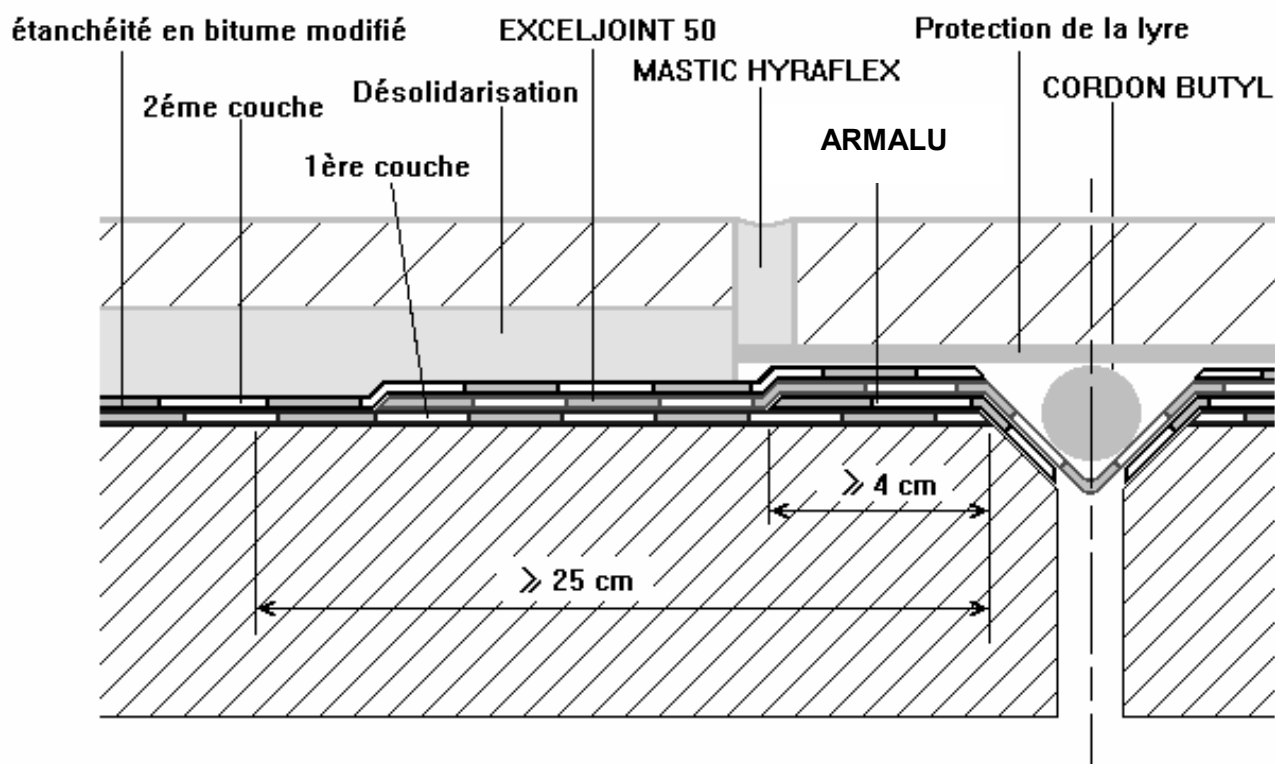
Joint plat en partie courante raccordé à une étanchéité en bitume modifié
